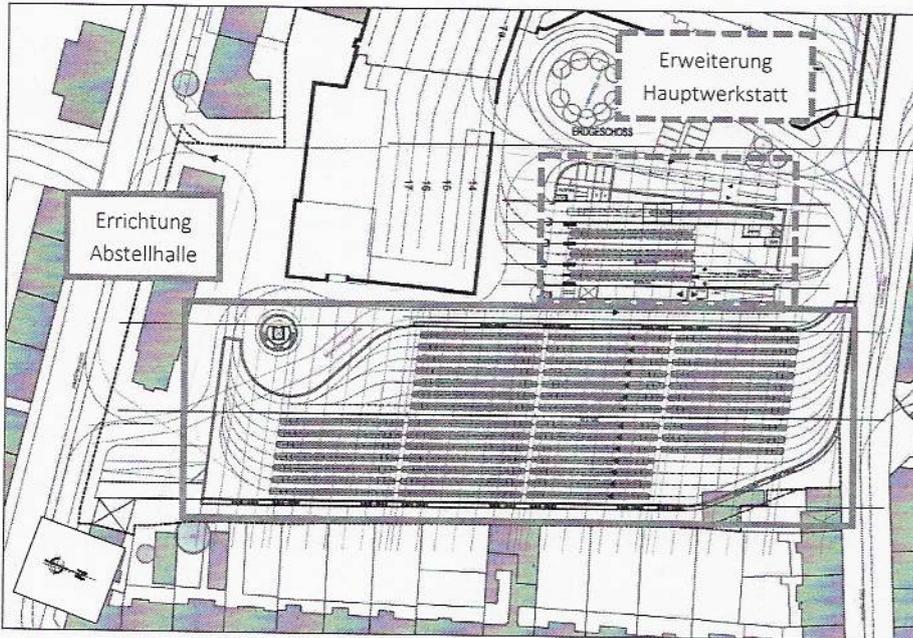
Erdgeschoß mit Abstellhalle und Betriebswerkstatt
